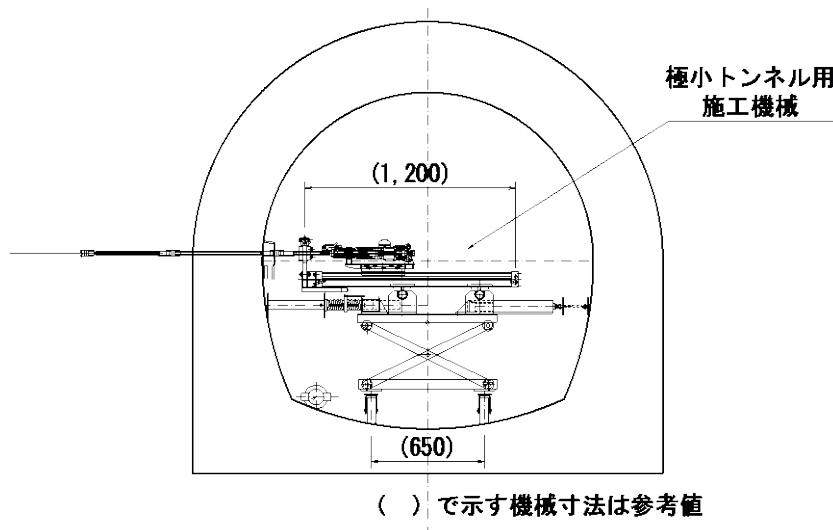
極小断面用ロックボルト施工機械配置図（例）
